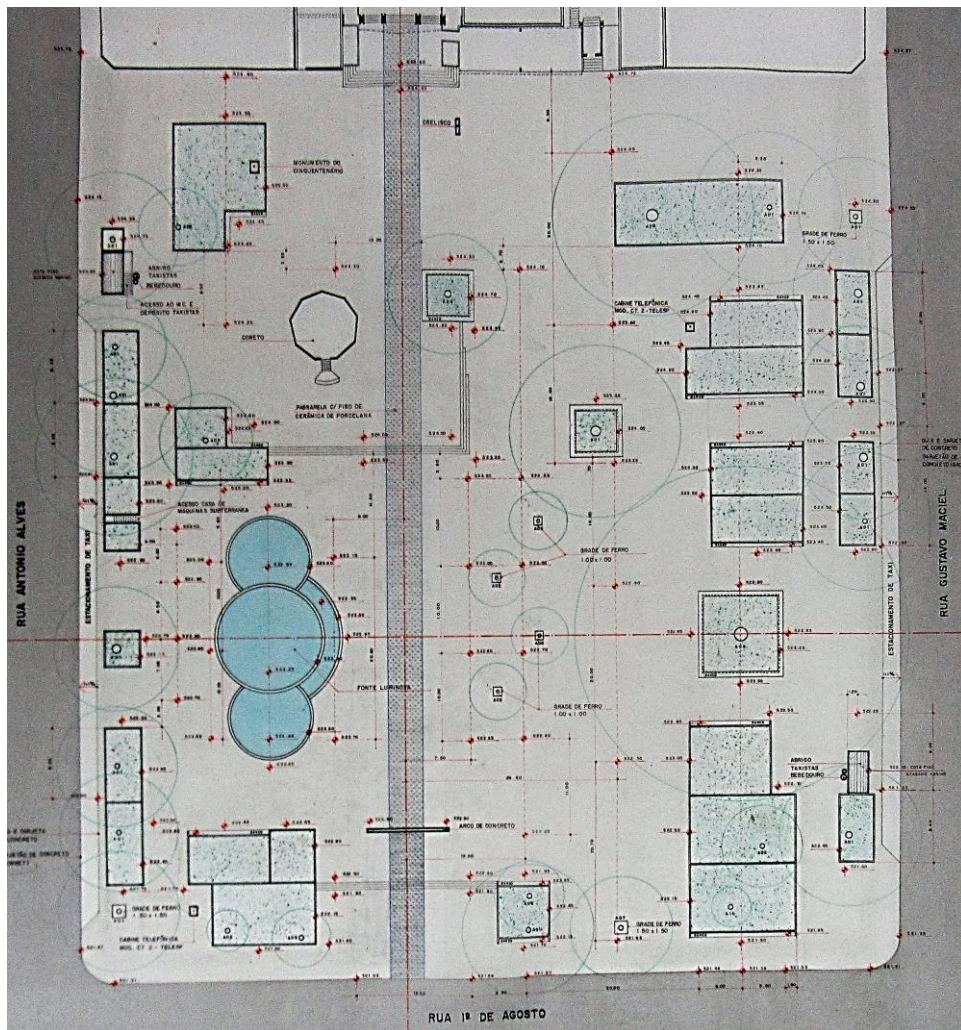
Planta baixa reforma da praça Rui Barbosa, 1990.
